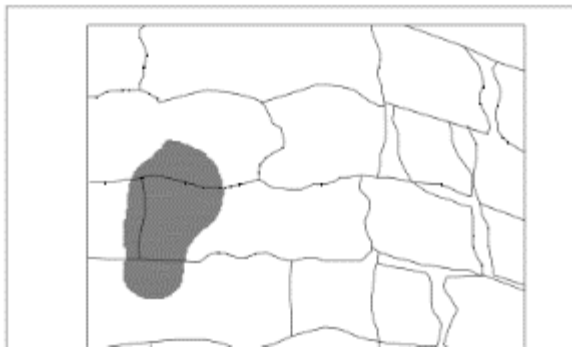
Fisuras Humedad en los muros/
